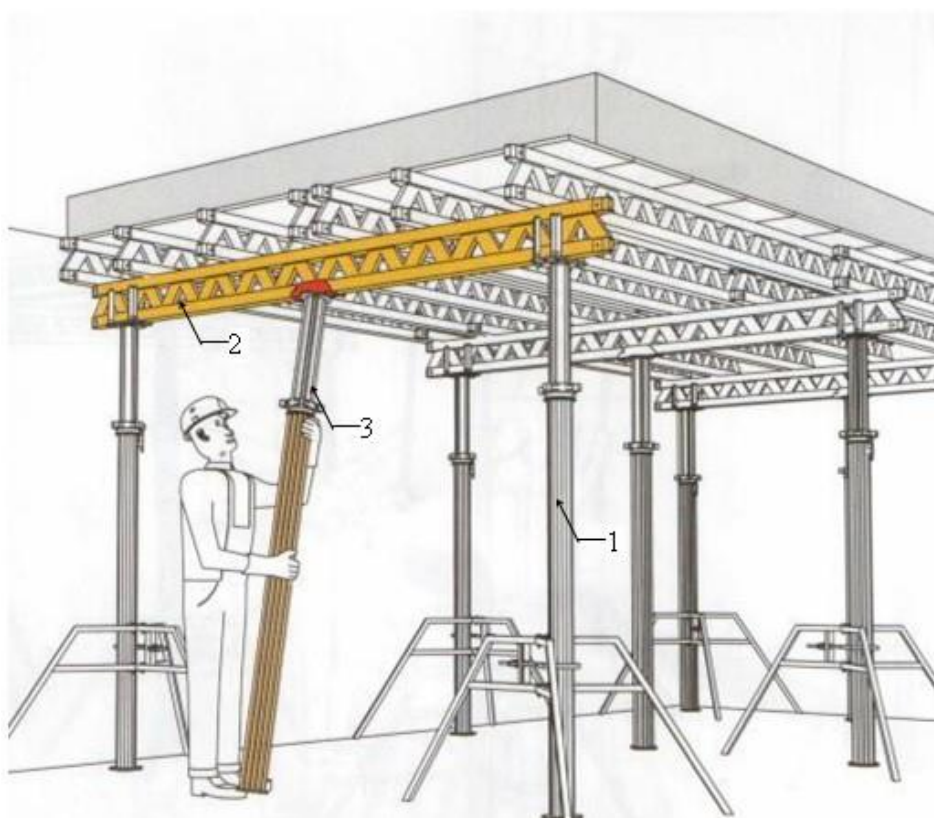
Опалубка перекрытий: 1-основная стойка; 2-продольная балка; 3- промежуточная стойка
